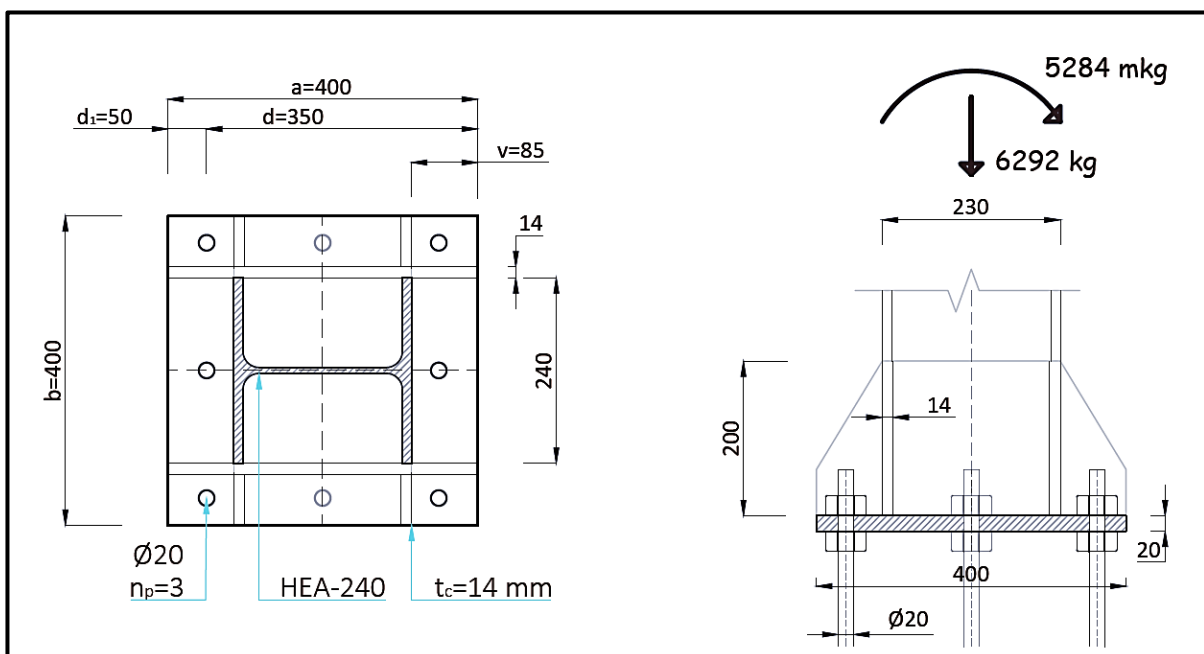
Dimensiones de la placa de anclaje para pilar HEA-240.
